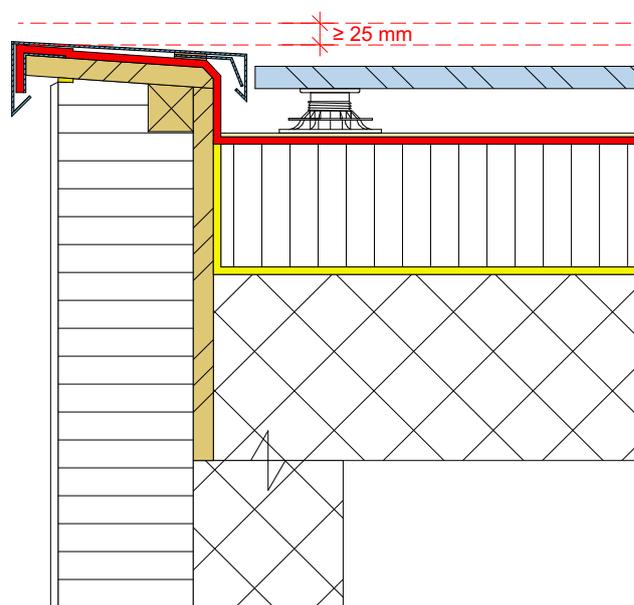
Il bordo del tetto con protezione antitrabocco e senza troppopieno deve trovarsi 25 mm al di sotto del bordo libero. Norma 271:2021 Art. 2.8.1.5 Figura 5
